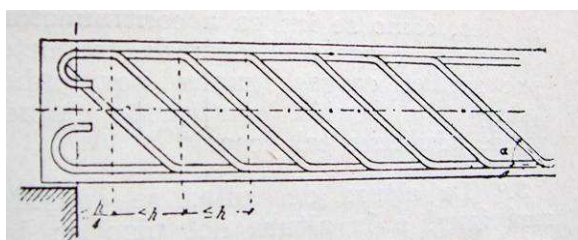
Separación máxima de las barras levantadas según la norma de 1941 (DGA, 1941).
